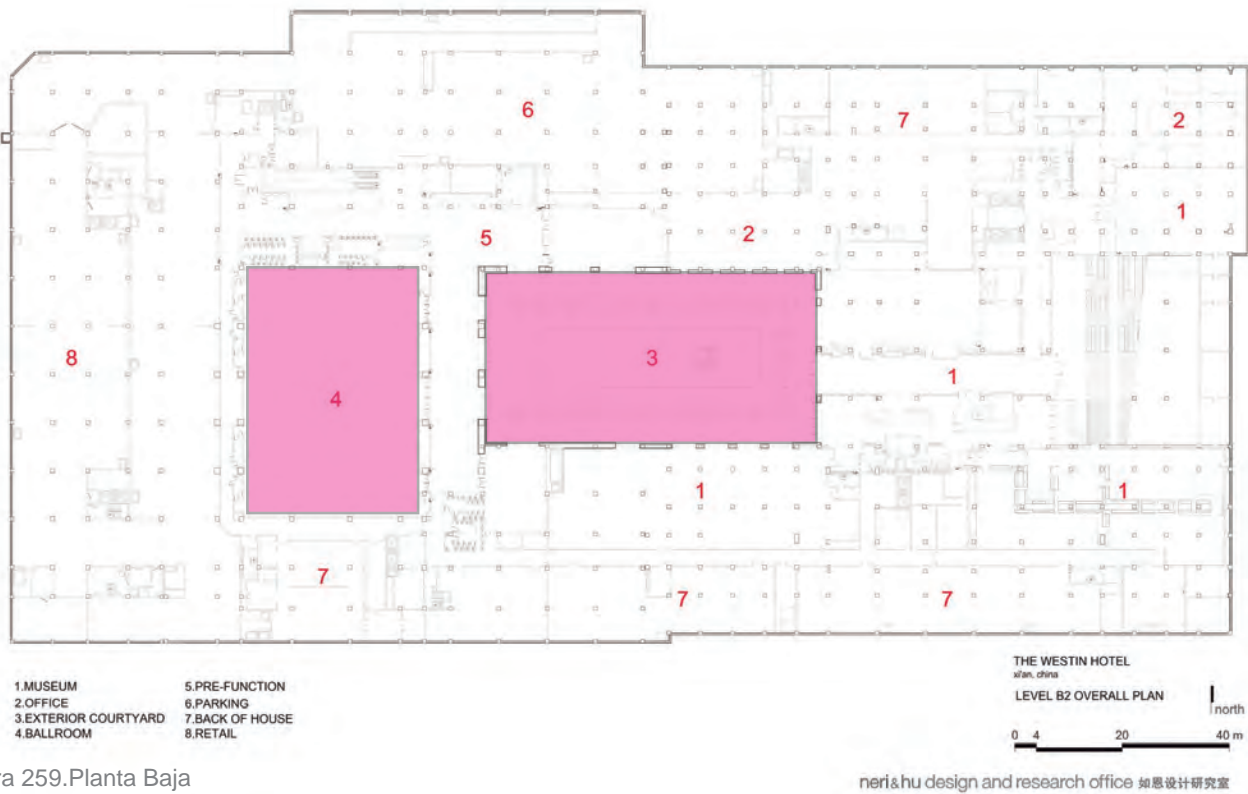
Planta Baja Adaptado de Neri & Hu, s.f.
